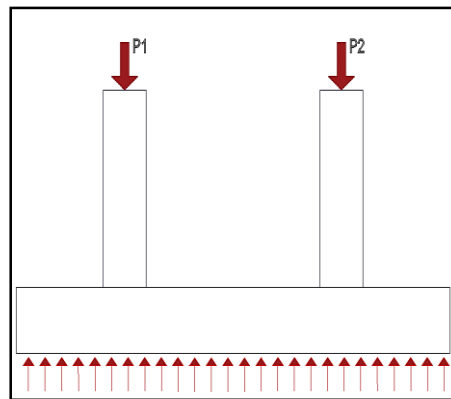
Esquema básico de zapatas combinada sin viga rígida en 3D.
